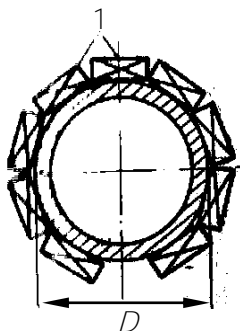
Взрывание пустотелой стальной колонны (трубы) наружным зарядом из тротиловых шашек: 1 – заряд
